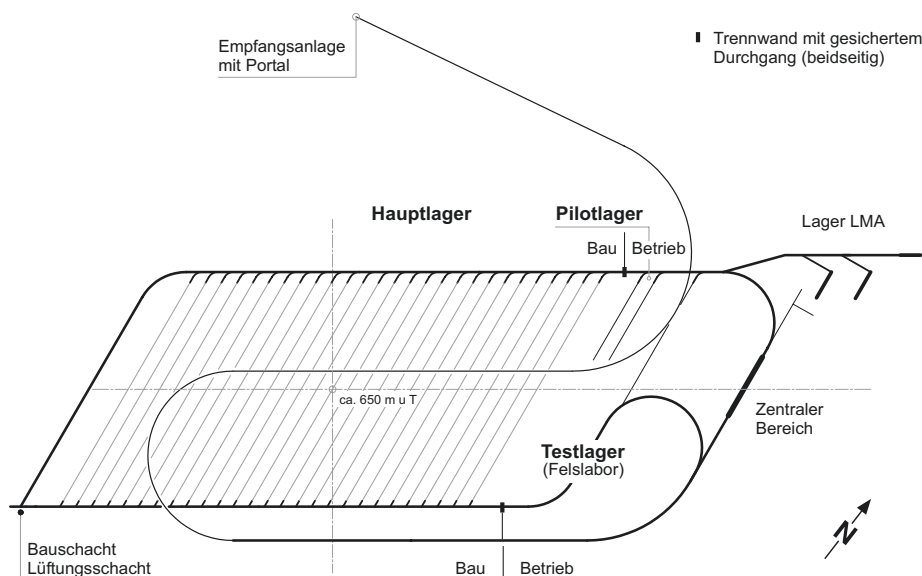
Bau der Lageranlage – Situation am Schluss der Bauetappe 2
